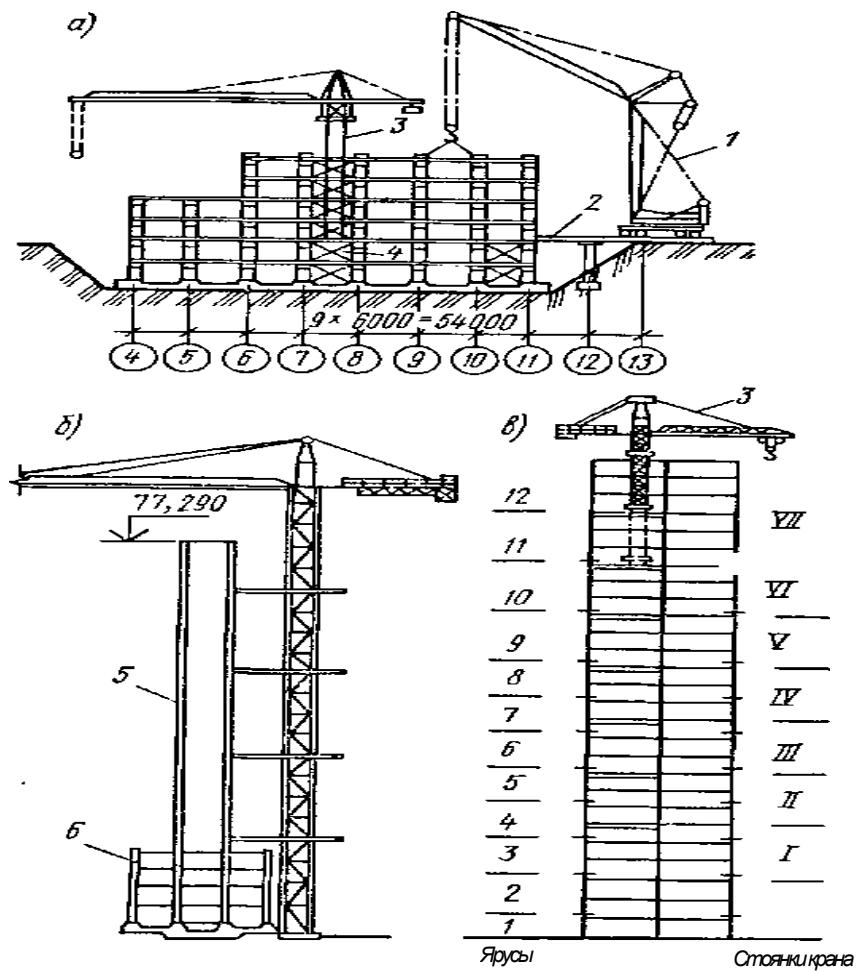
Принципиальная схема возведения высотных зданий:
